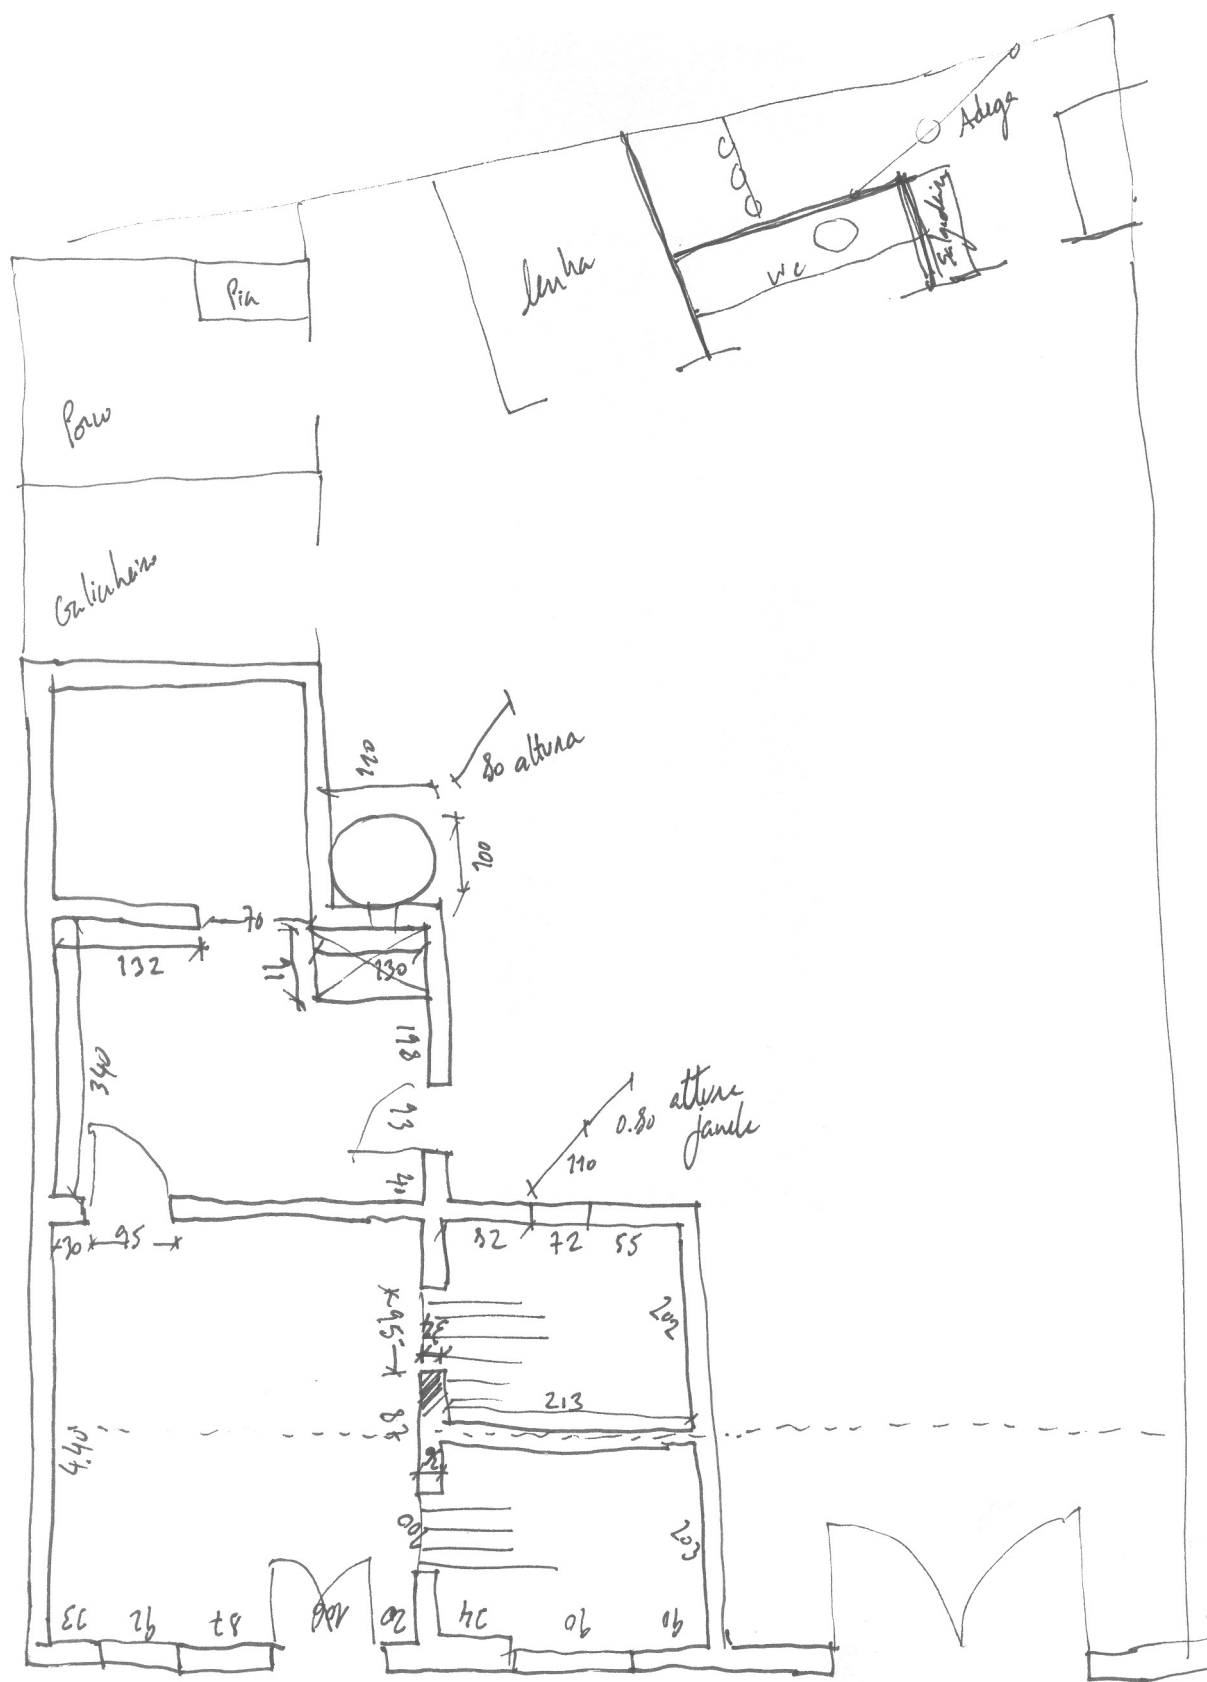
Planta de levantamento. Casa Pátio [Aveiro4] , pág. 89
